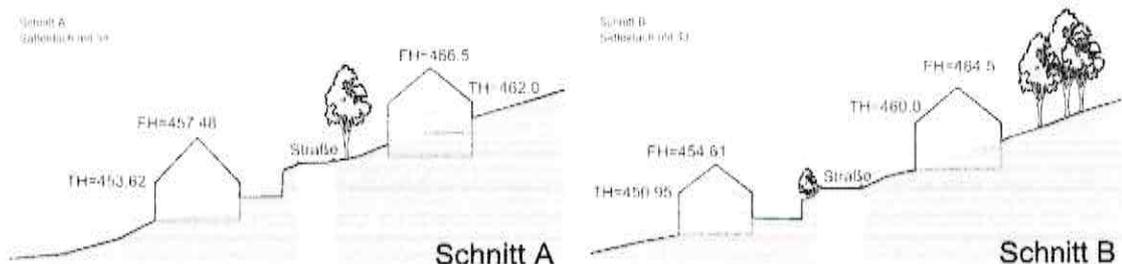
Schematische Darstellung einer möglichen Bebauung im Schnitt mit Satteldach zusammen mit der bestehenden Bebauung (eigene Darstellung)
